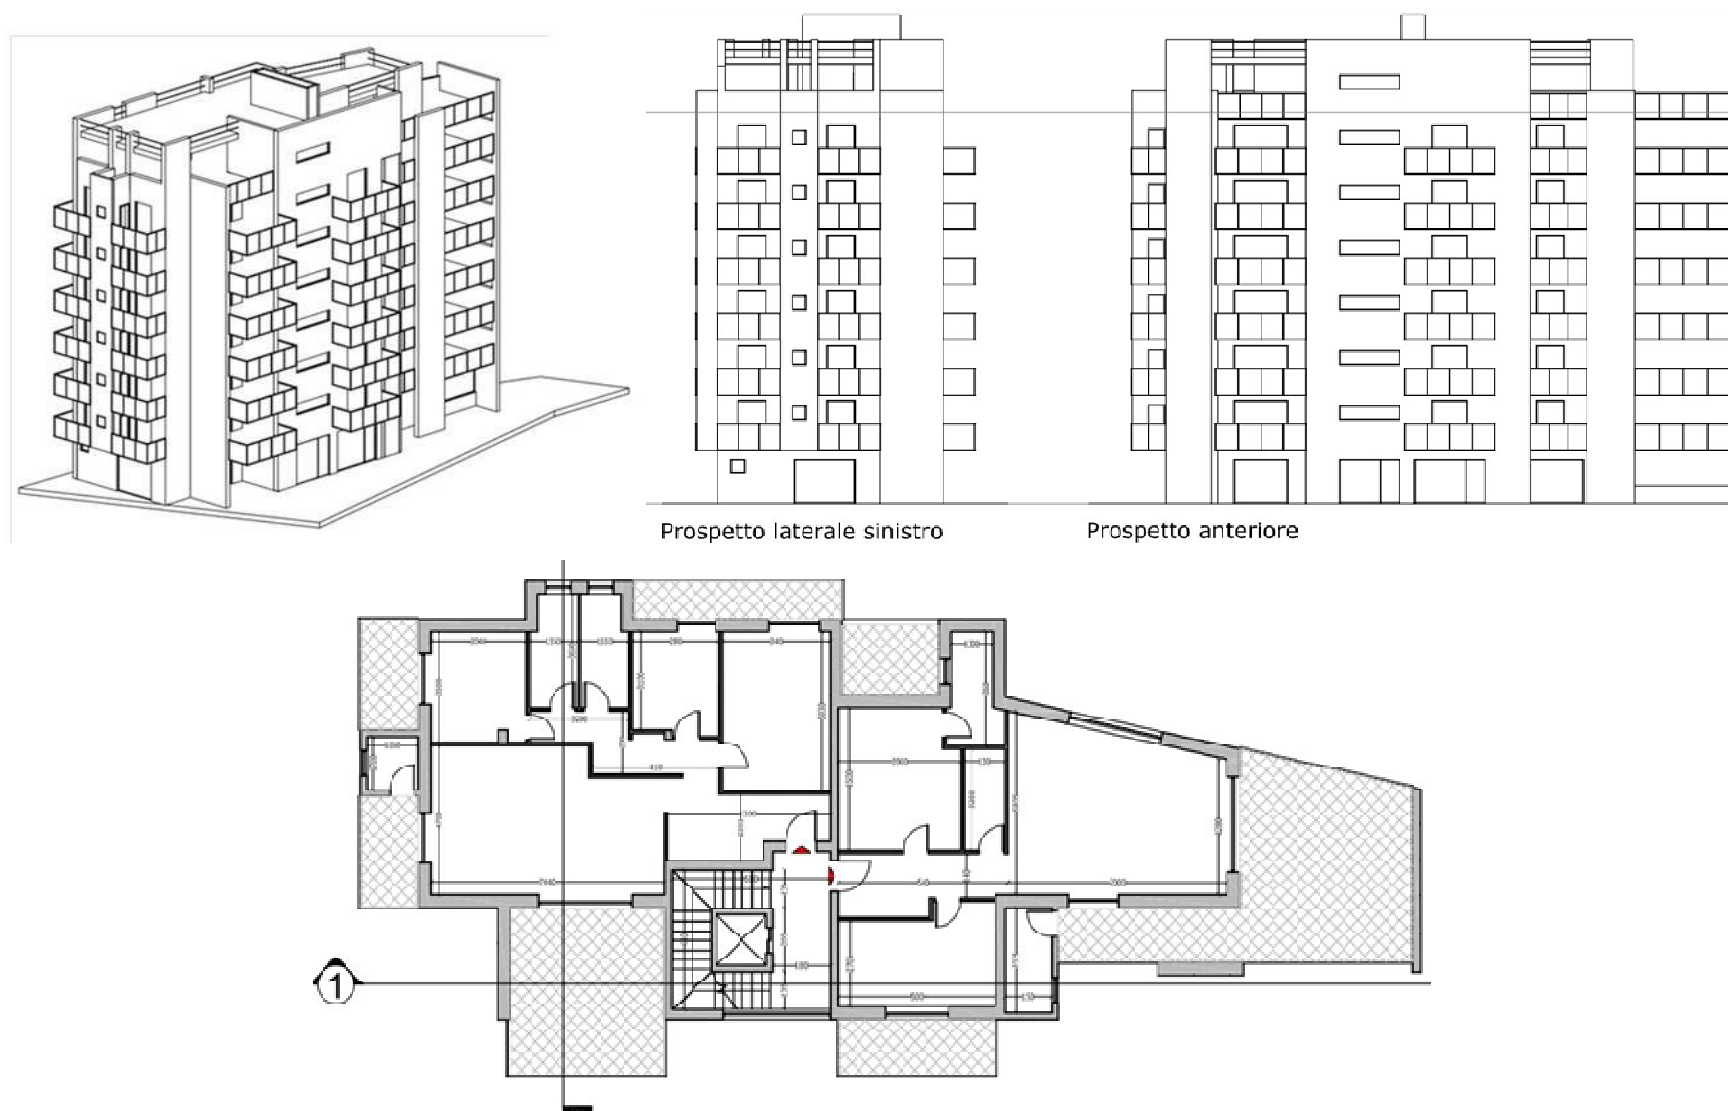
Blocco A4 – Assonometria, prospetto anteriore, prospetto laterale sinistro e pianta del piano tipo
